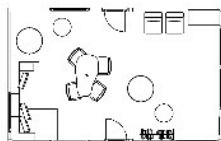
Planta Edificio 2, Zona 1, sin escala.
